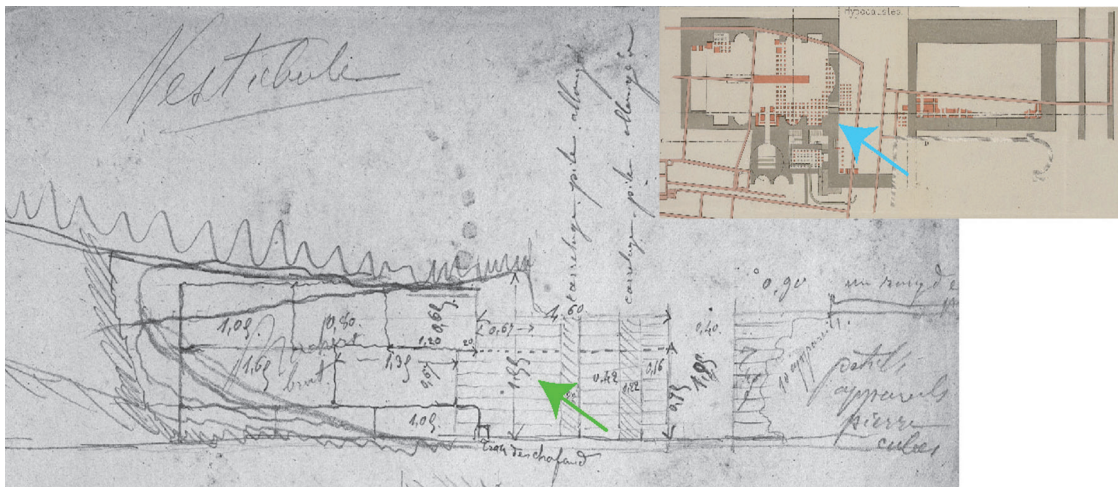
Relevé pierre à pierre d'une partie du parement d'un mur de la salle centrale des thermes (flèche bleue) avec indication de la hauteur de l'élévation (flèche verte). Document FRAD86\_16J3\_117\_124.
